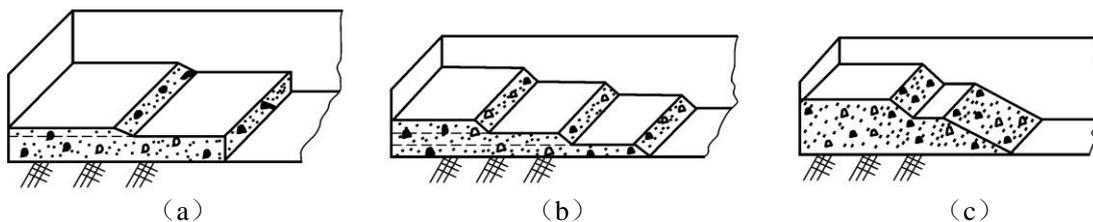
大块体钢筋混凝土地基的 3 种浇筑方法
